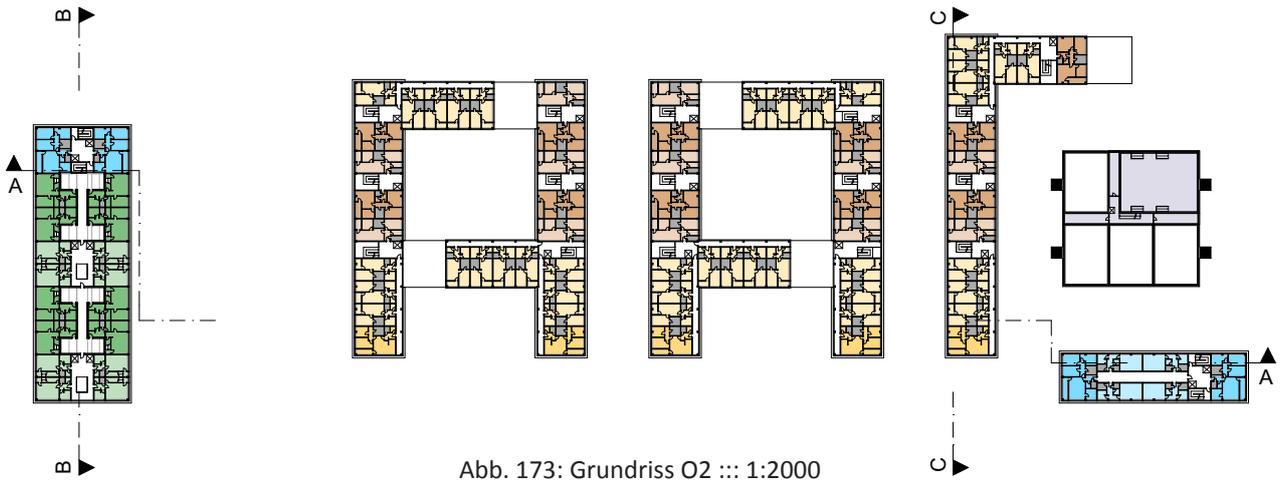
Grundriss O2 ::: 1:2000
